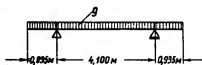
Расчетная схема настила и схема нагрузок при монтаже.
